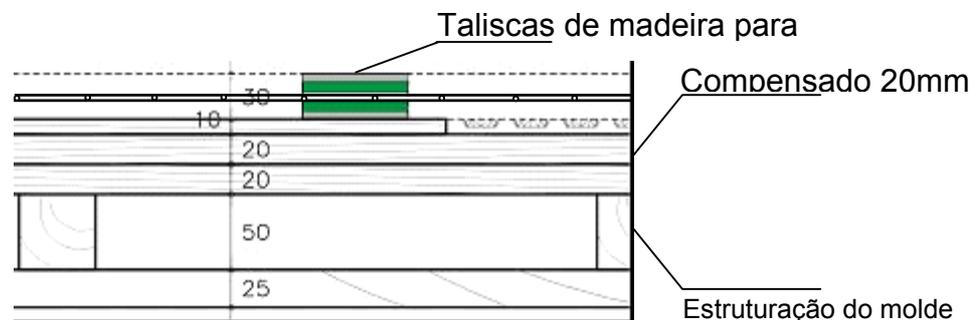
Detalhe da armadura já instalada na fôrma de madeira
